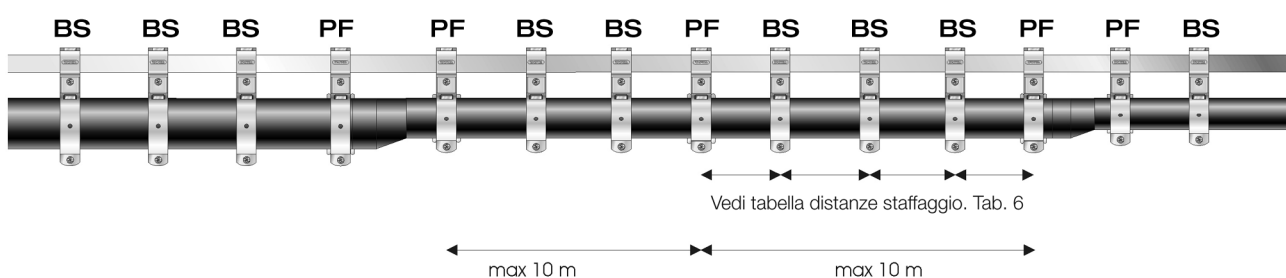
Collocazione dei bracciali a punto fisso nel collettore orizzontale.
